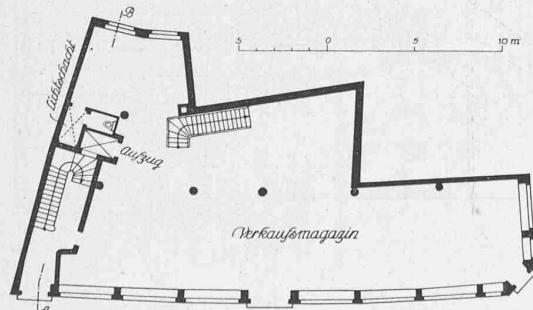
Grundriss des Kaufhauses Gebr. Hess A.-G.
